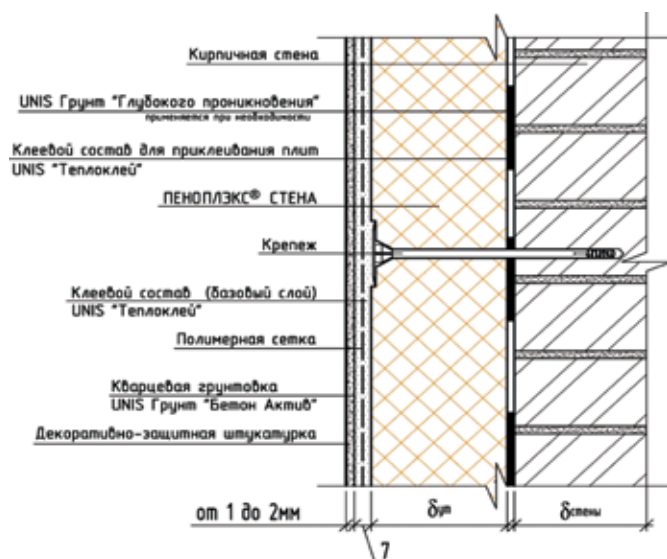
Конструкция наружной стены здания № 2 (кирпич – ПЕНОПЛЭКС Стена – тонкослойная штукатурка)
